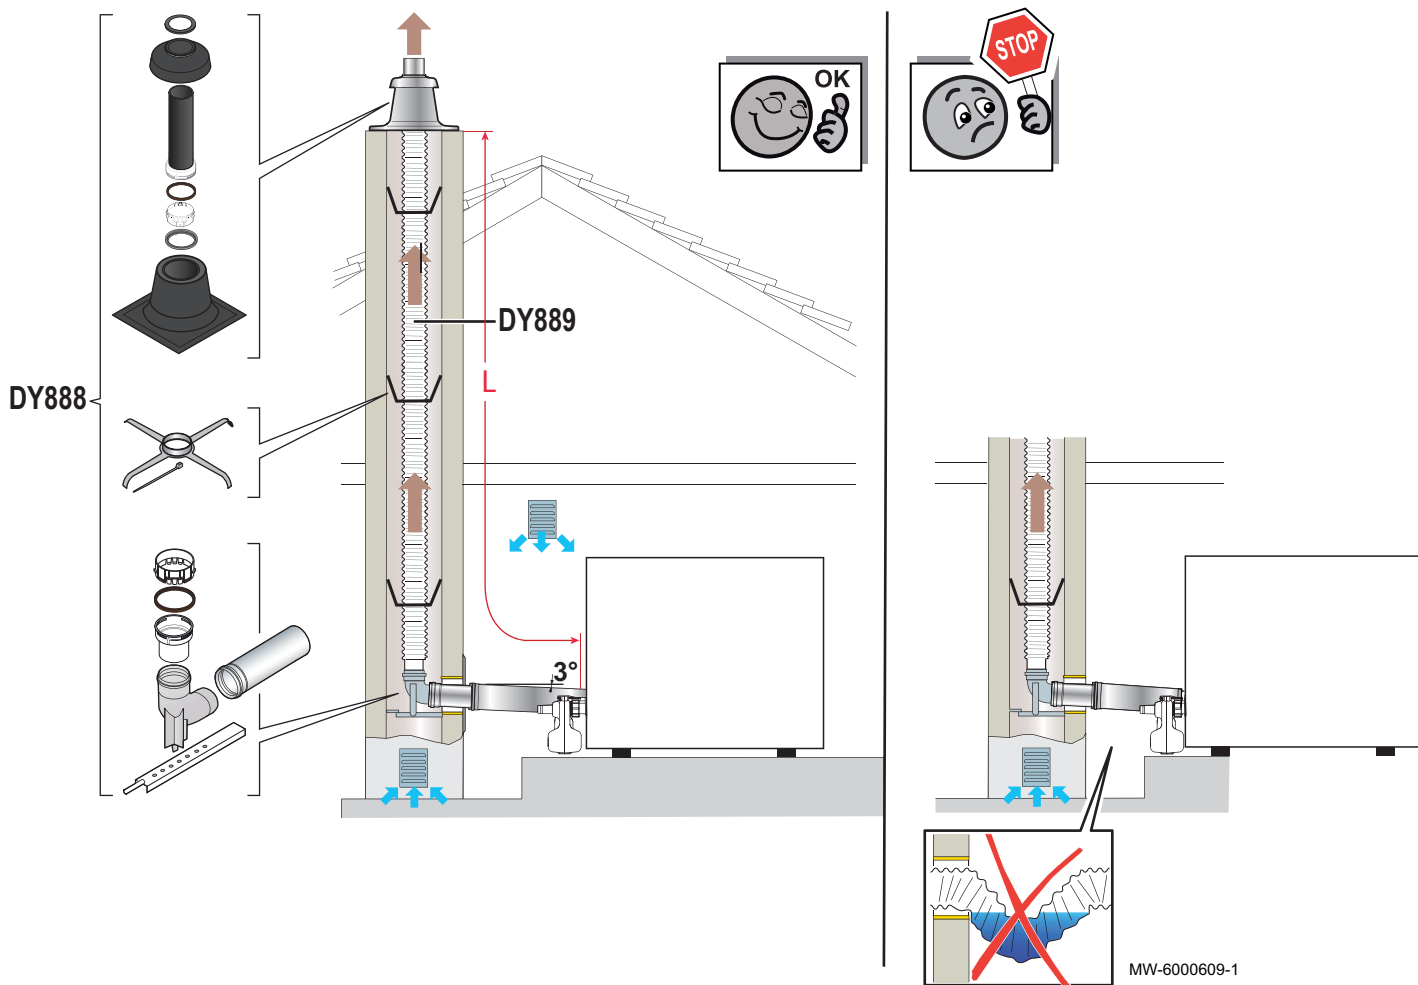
Raccordement de type B<sub>23P</sub> en rigide - Conduits de fumées (air comburant pris dans la chaufferie)
